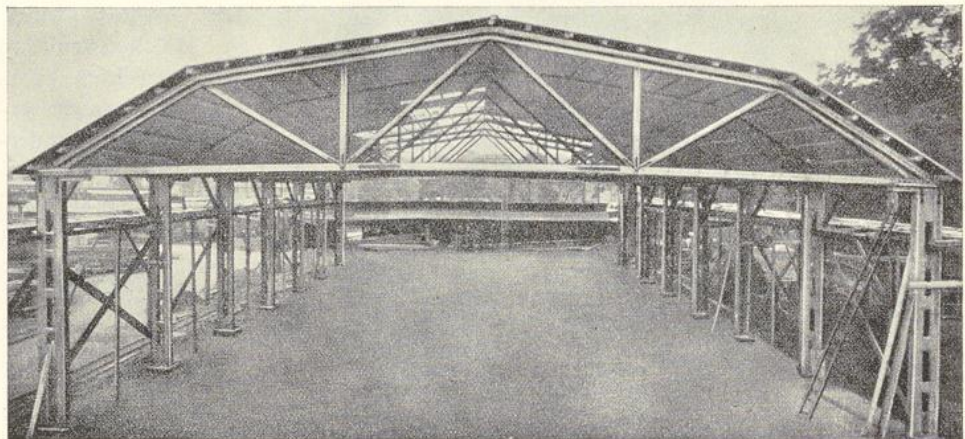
Hallenbau in „Holzbau System Meltzer“, Eisenlager der R. B. D., Nürnberg.
